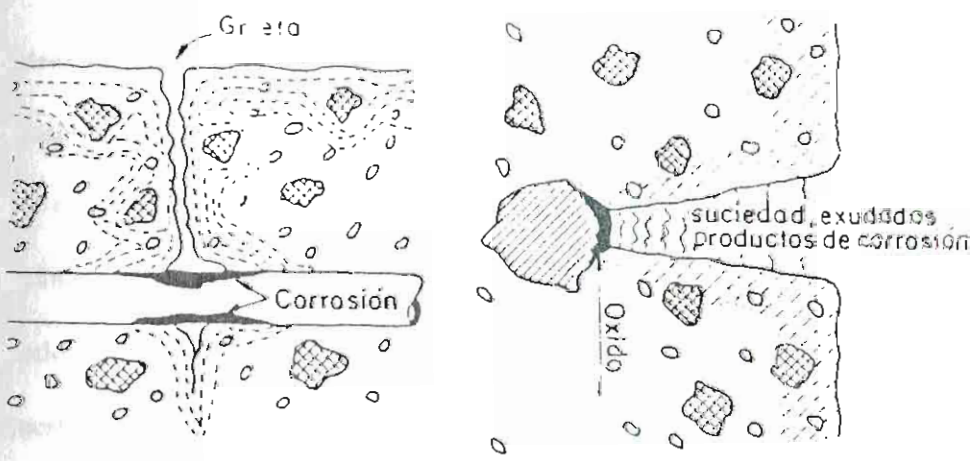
Corrosión en fisuras transversales y longitudinales
